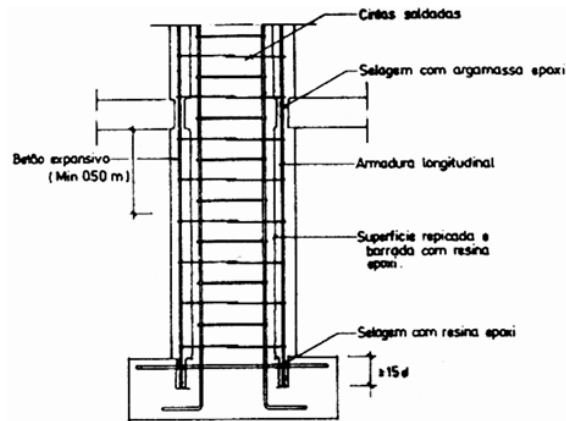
Reforço de pilar por encamisamento de betão armado, com pormenor da ancoragem das armaduras de fundação (1).
